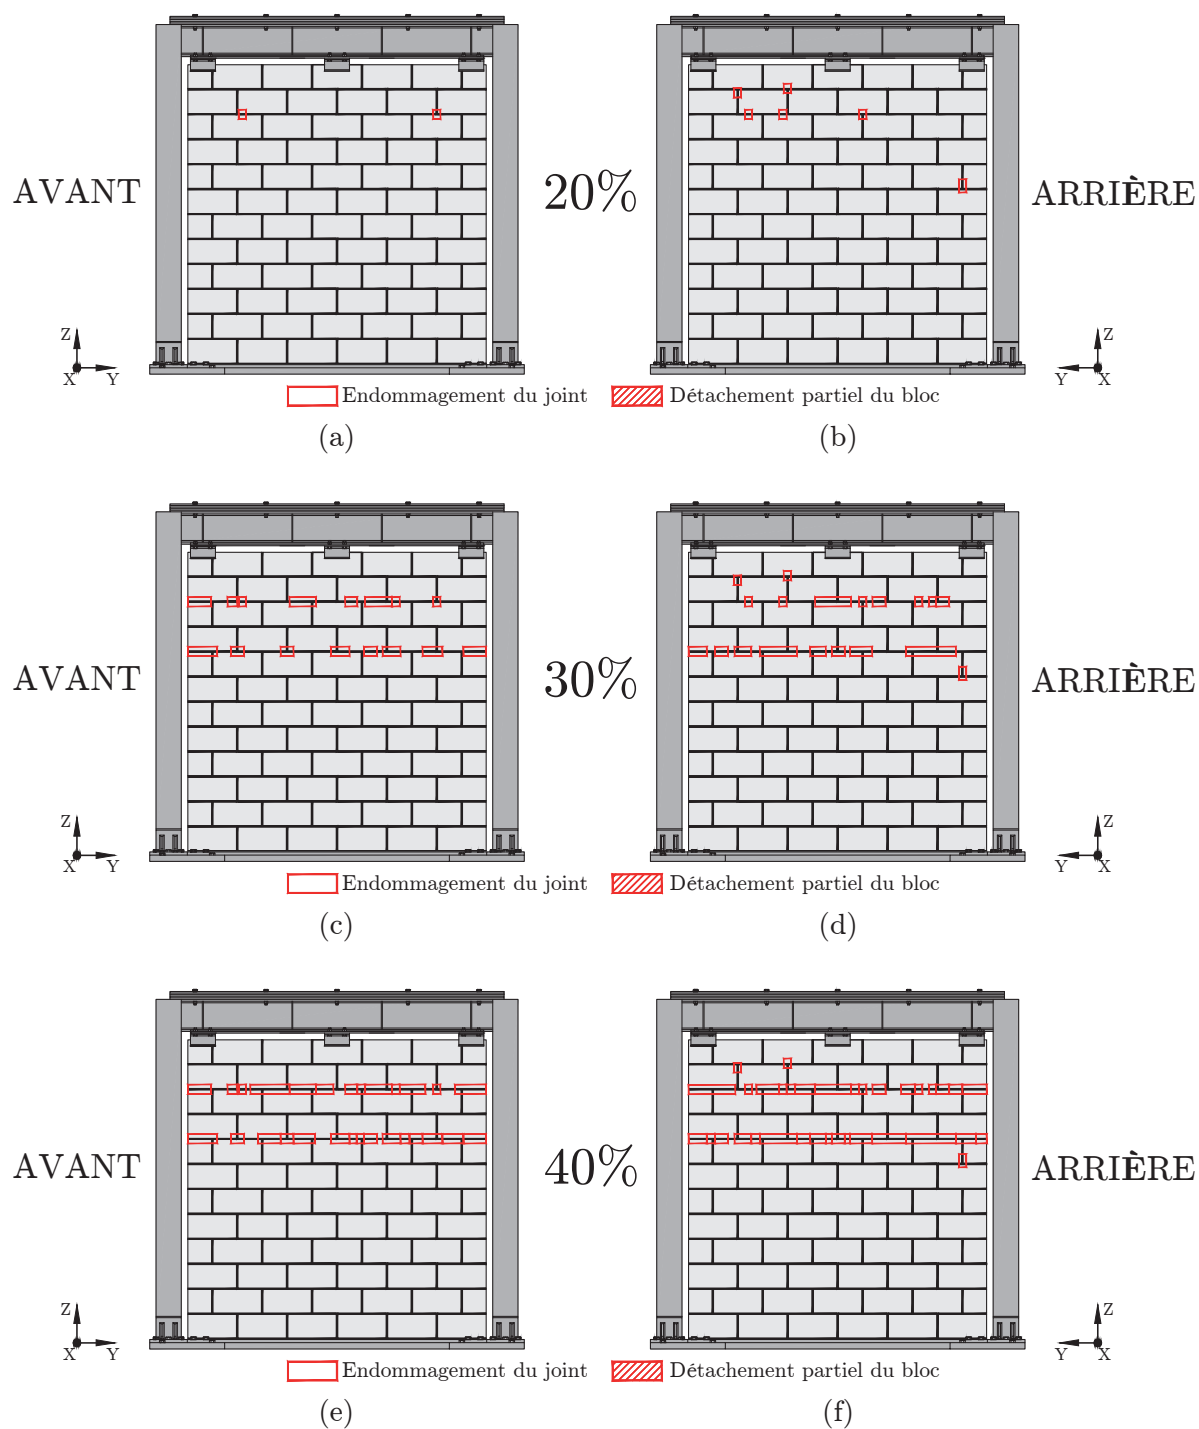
Représentation visuelle de l'endommagement du mur 2 après l'essai (a) MAL6-0.20 - façade avant (b) MAL6-0.20 - façade arrière (c) MAL7-0.30 - façade avant (d) MAL7-0.30 - façade arrière (e) MAL9-0.40 - façade avant (f) MAL9-0.40 - façade arrière
